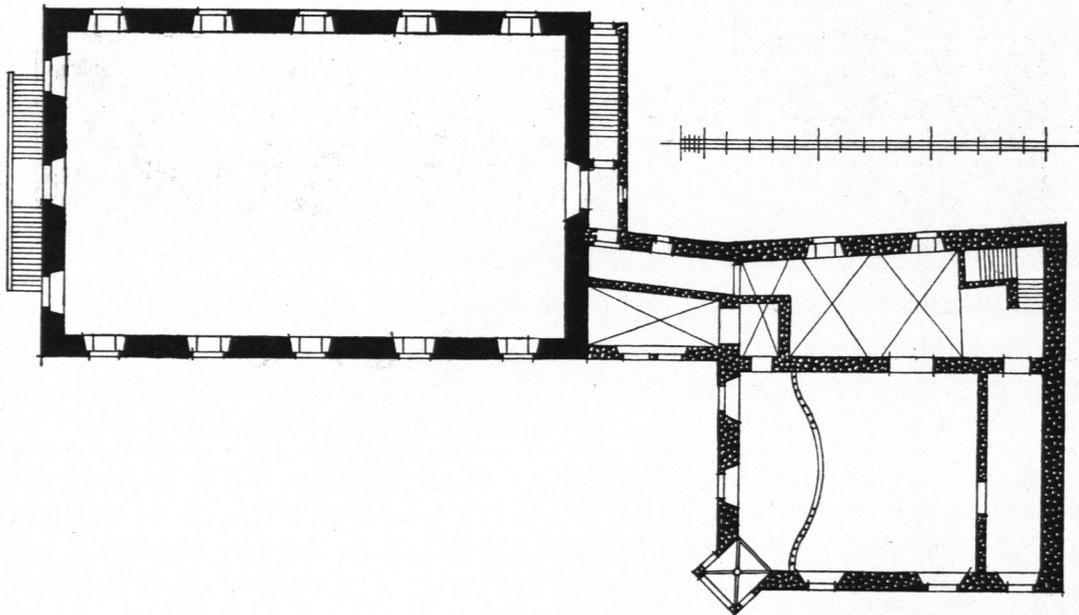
Rathaus zu Cham. Grundriß des ersten Stockwerkes.
